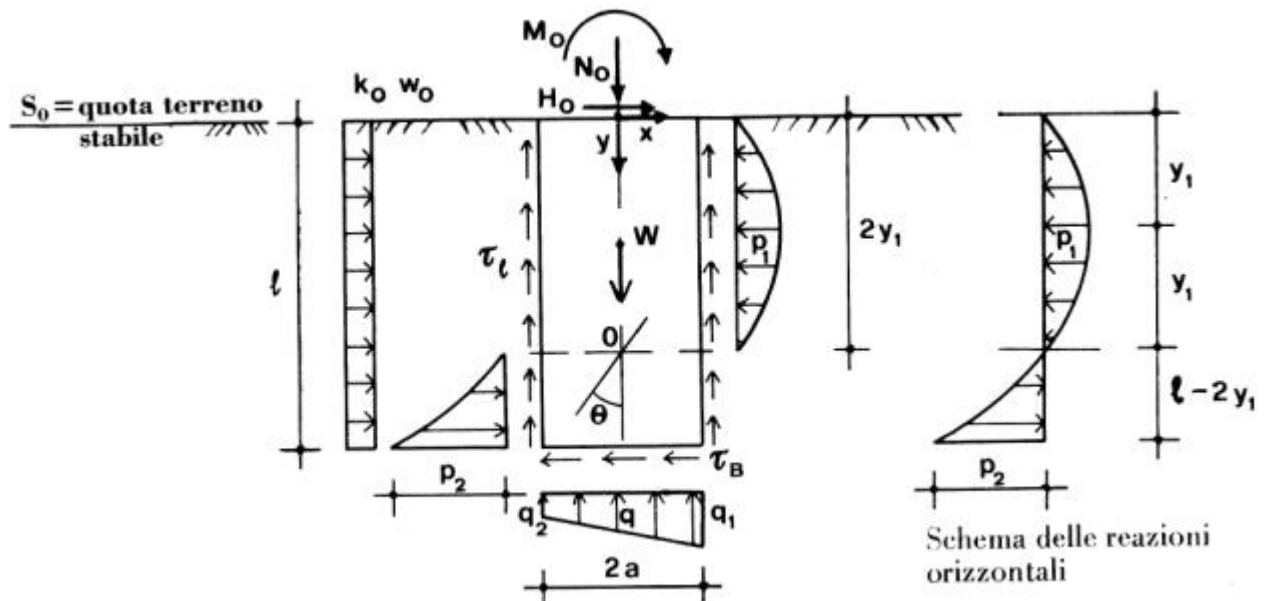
schema di funzionamento fondazione a pozzo - Ikehara
